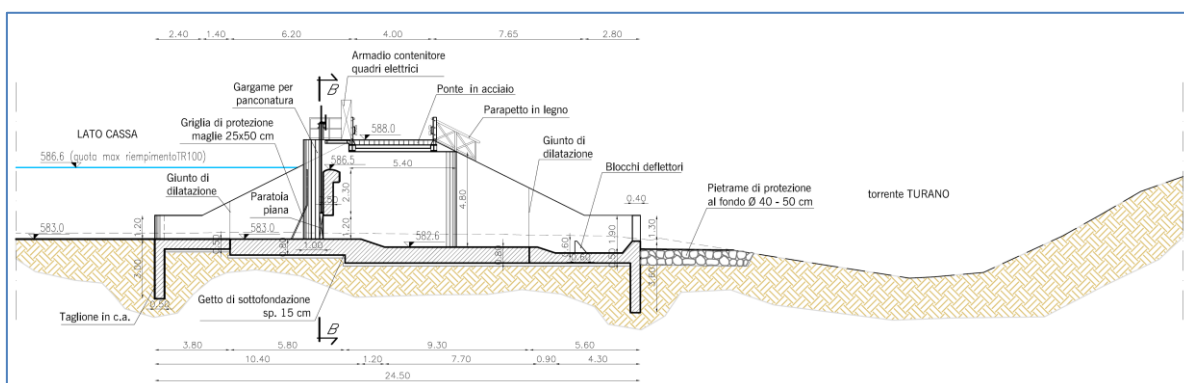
Cassa sul T. Turano. Sezione longitudinale della traversa di regolazione.
